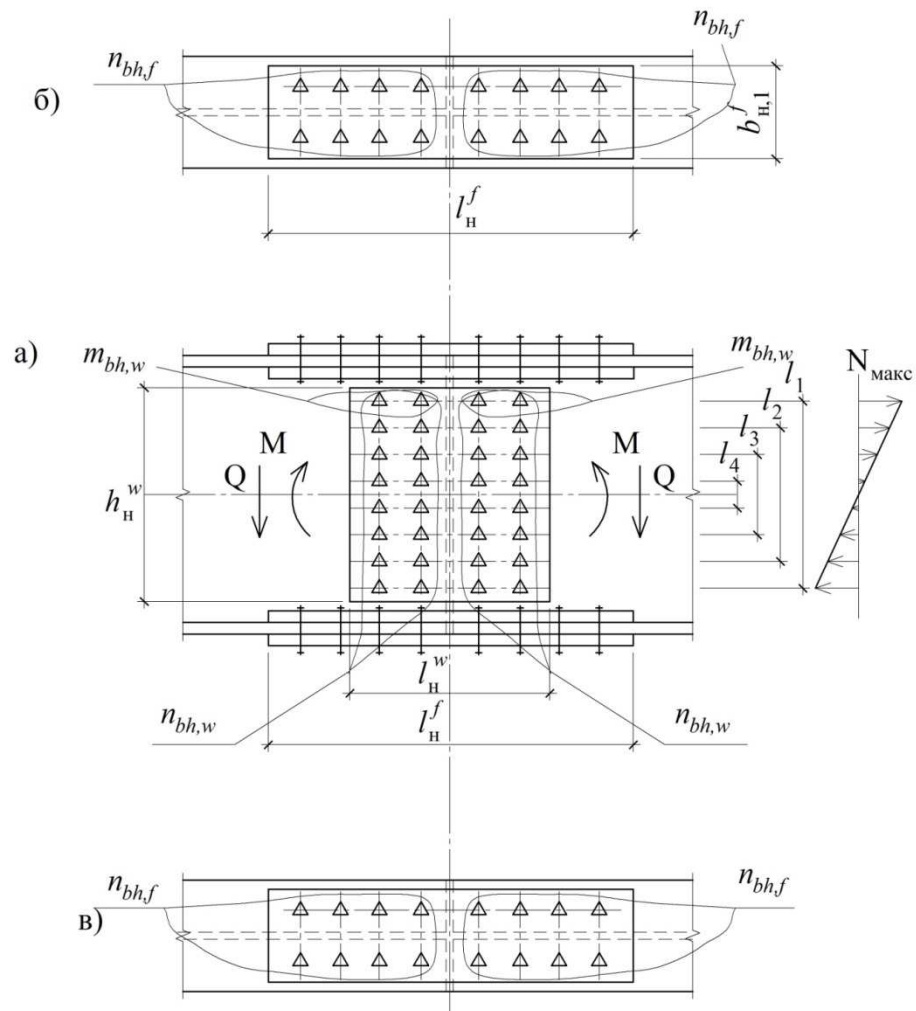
Монтажный стык отправочных марок балок на высокопрочных болтах с помощью накладок на поясах и стенке; а) основная проекция; б) вид сверху; в) вид снизу
